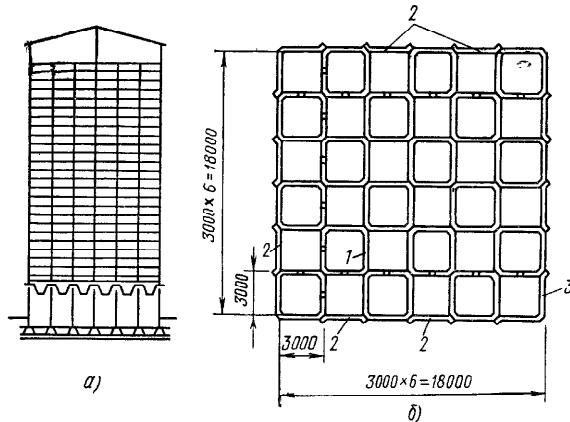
Схема компоновки корпуса из квадратных силосов:
